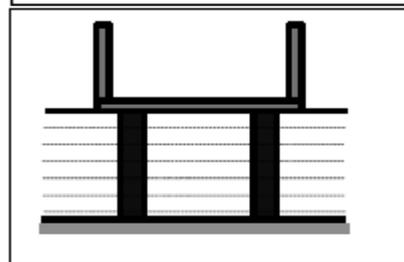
Fouilles en trous pour fondations : Elles correspondent aux semelles isolées (ex: fondations sous les poteaux, sous les murs isolés de petites dimensions).
